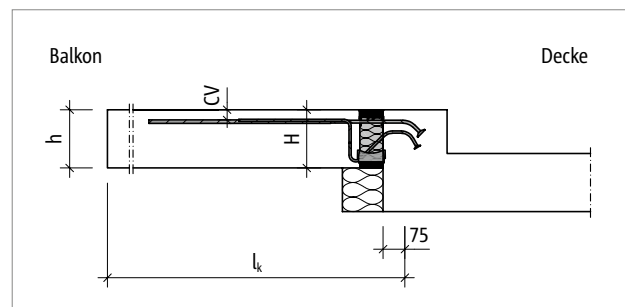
Schöck Isokorb® T Typ KL-O: Statisches System
